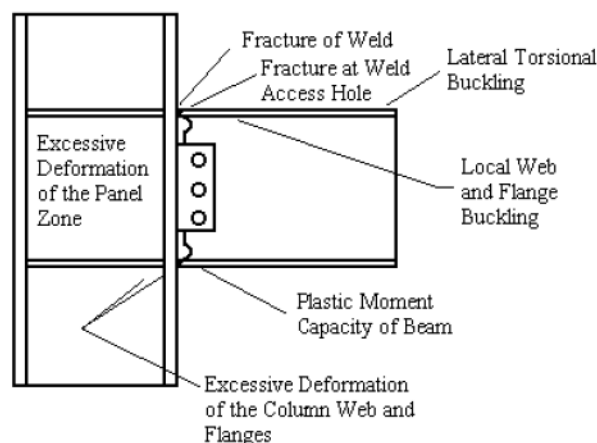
Mecanismo de falla para una conexión alas soldadas-alma empernada, FUENTE: FEMA 355 D.
